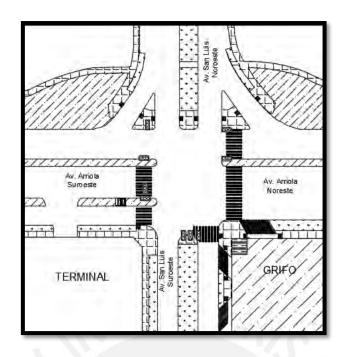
Levantamiento de sitio – Primer Punto Negro
